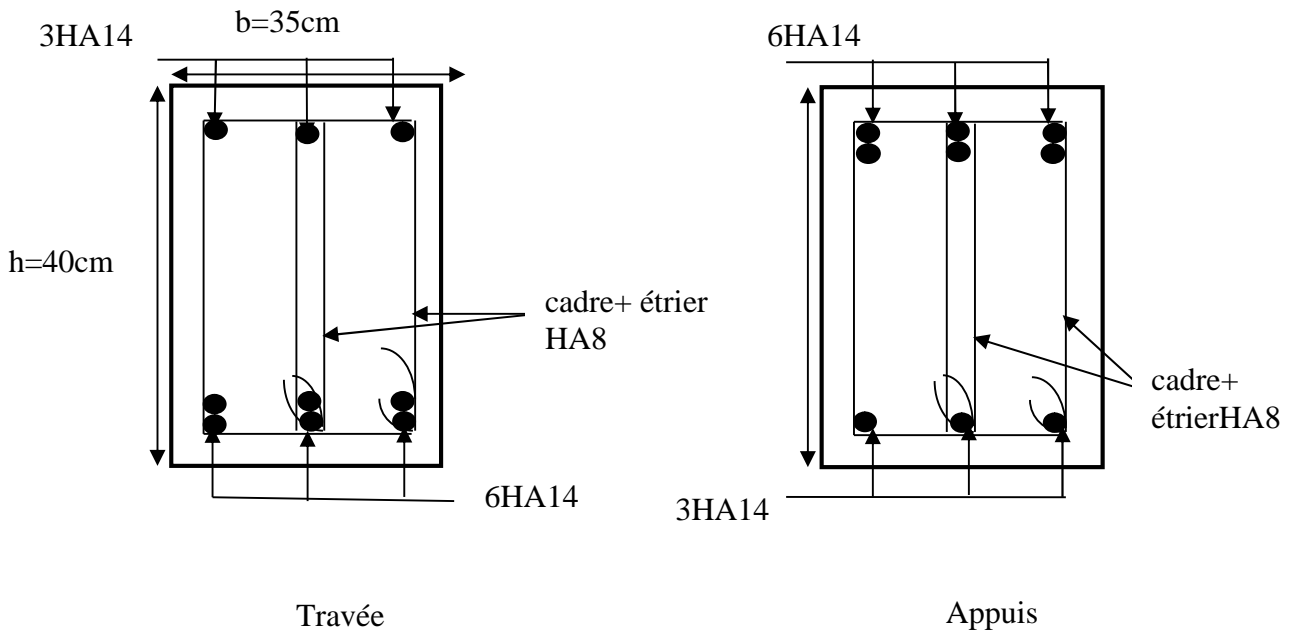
schémas de ferrailage des poutres principales de RDC+ l'étage
